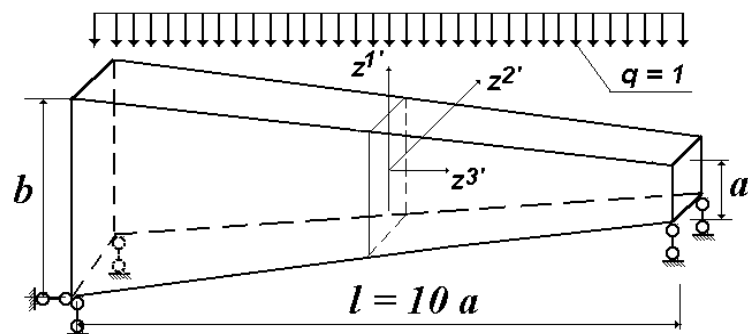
Розрахункова схема згину призматичного шарнірно опертого об'єкта
